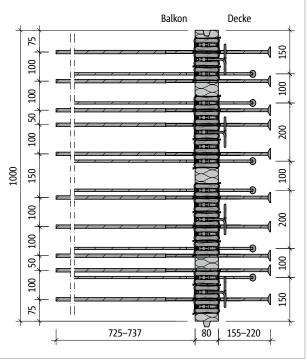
Schöck Isokorb® T Typ KL-U-M4: Produktgrundriss
